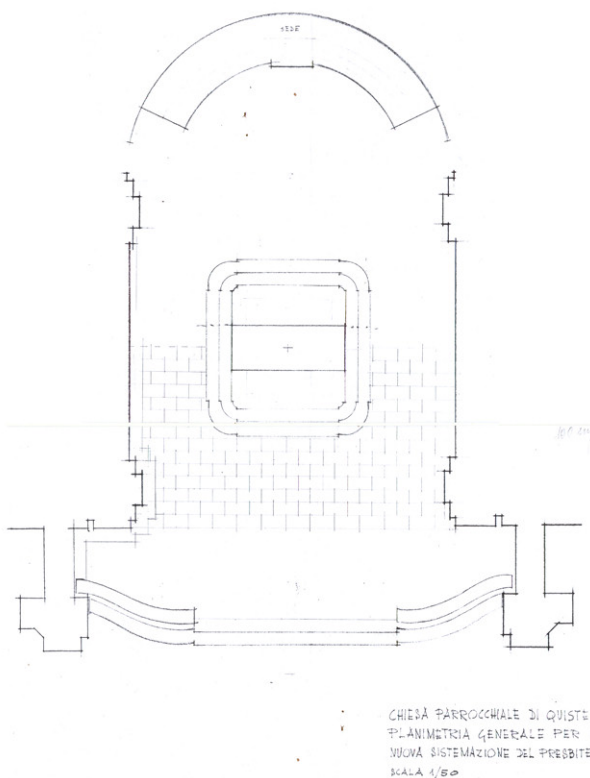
Disegno della sistemazione del presbiterio nella sua composizione attuale. Architetto Ivo Maretti. Dall'Archivio parrocchiale di Quistello.
